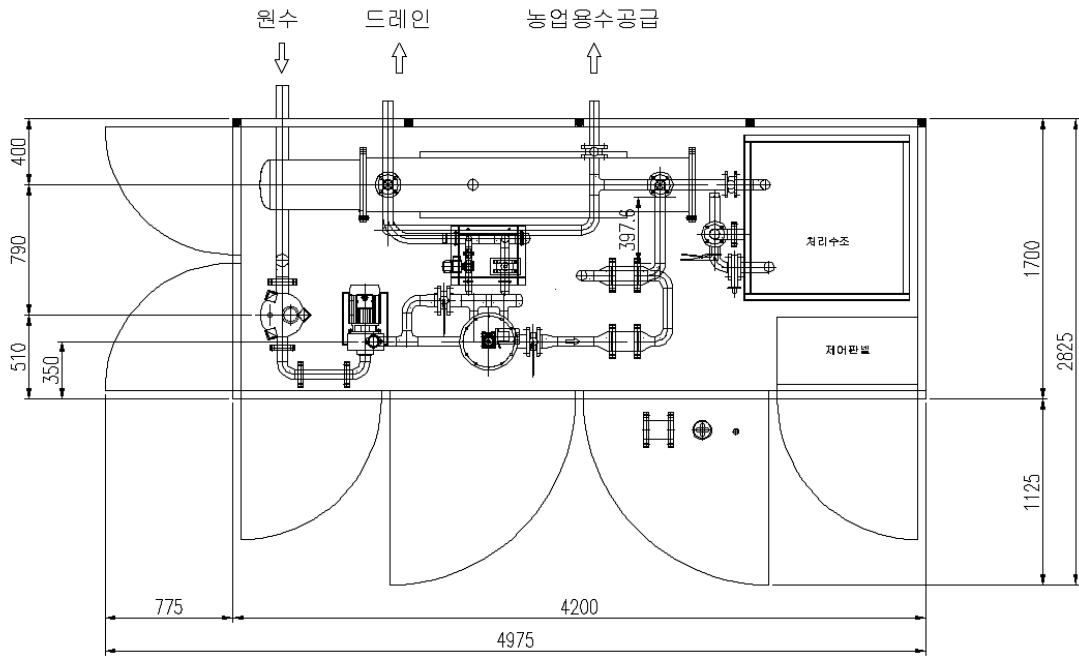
하천보 활용 소용량 간접재이용시스템 평면도
